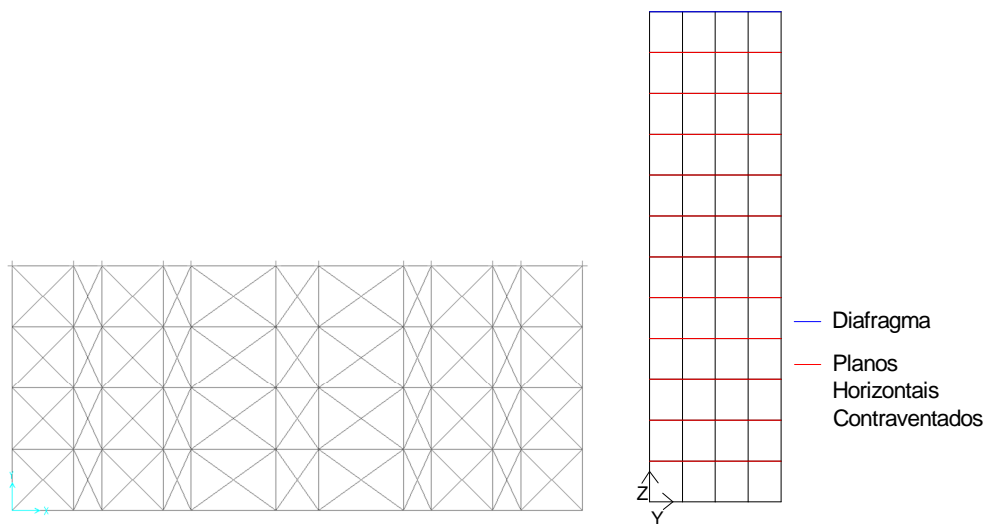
Configuração dos Planos de Contraventamento Horizontal Com Elementos de Contraventamento Pequenos
